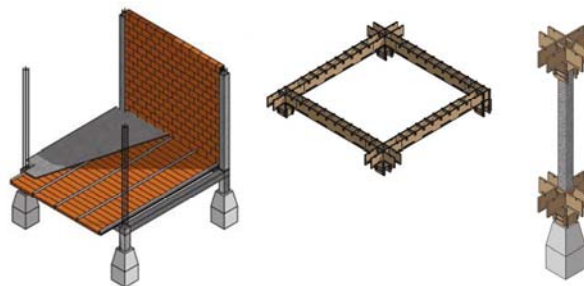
Arriba a la izquierda, diagrama de la propuesta de los componentes estructurales para fundaciones, columnas, machones y muros. En el centro, encofrado modular para vigas. A la derecha, encofrado para vigas de riostra y vigas acarteladas. (Mario Torres, 2011)
